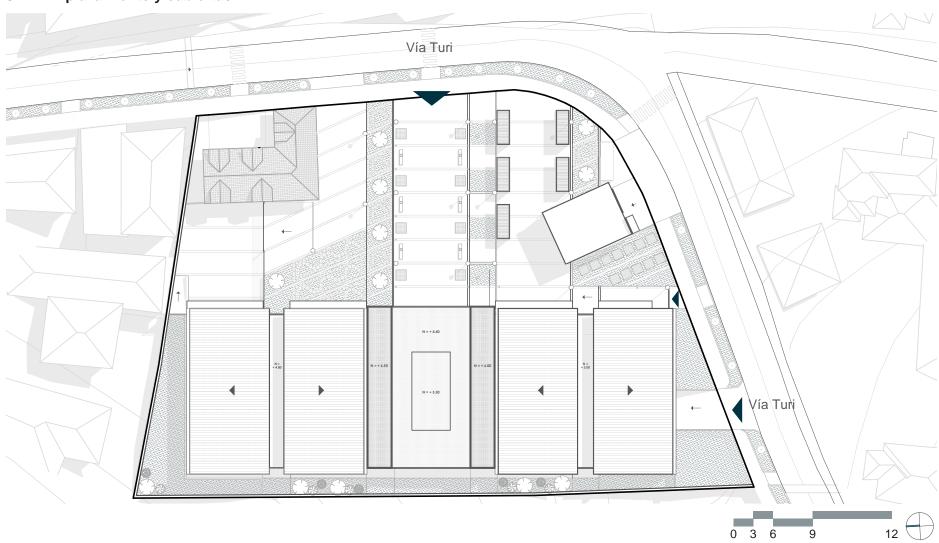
Plano general del emplazamiento y cubiertas. Fuente: Autores, 2024
